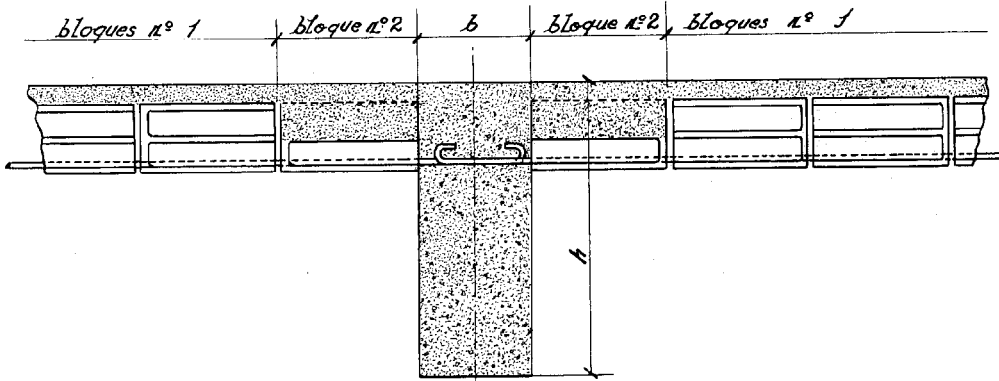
ª Detalle de organización de viga con cabeza de compresión.
